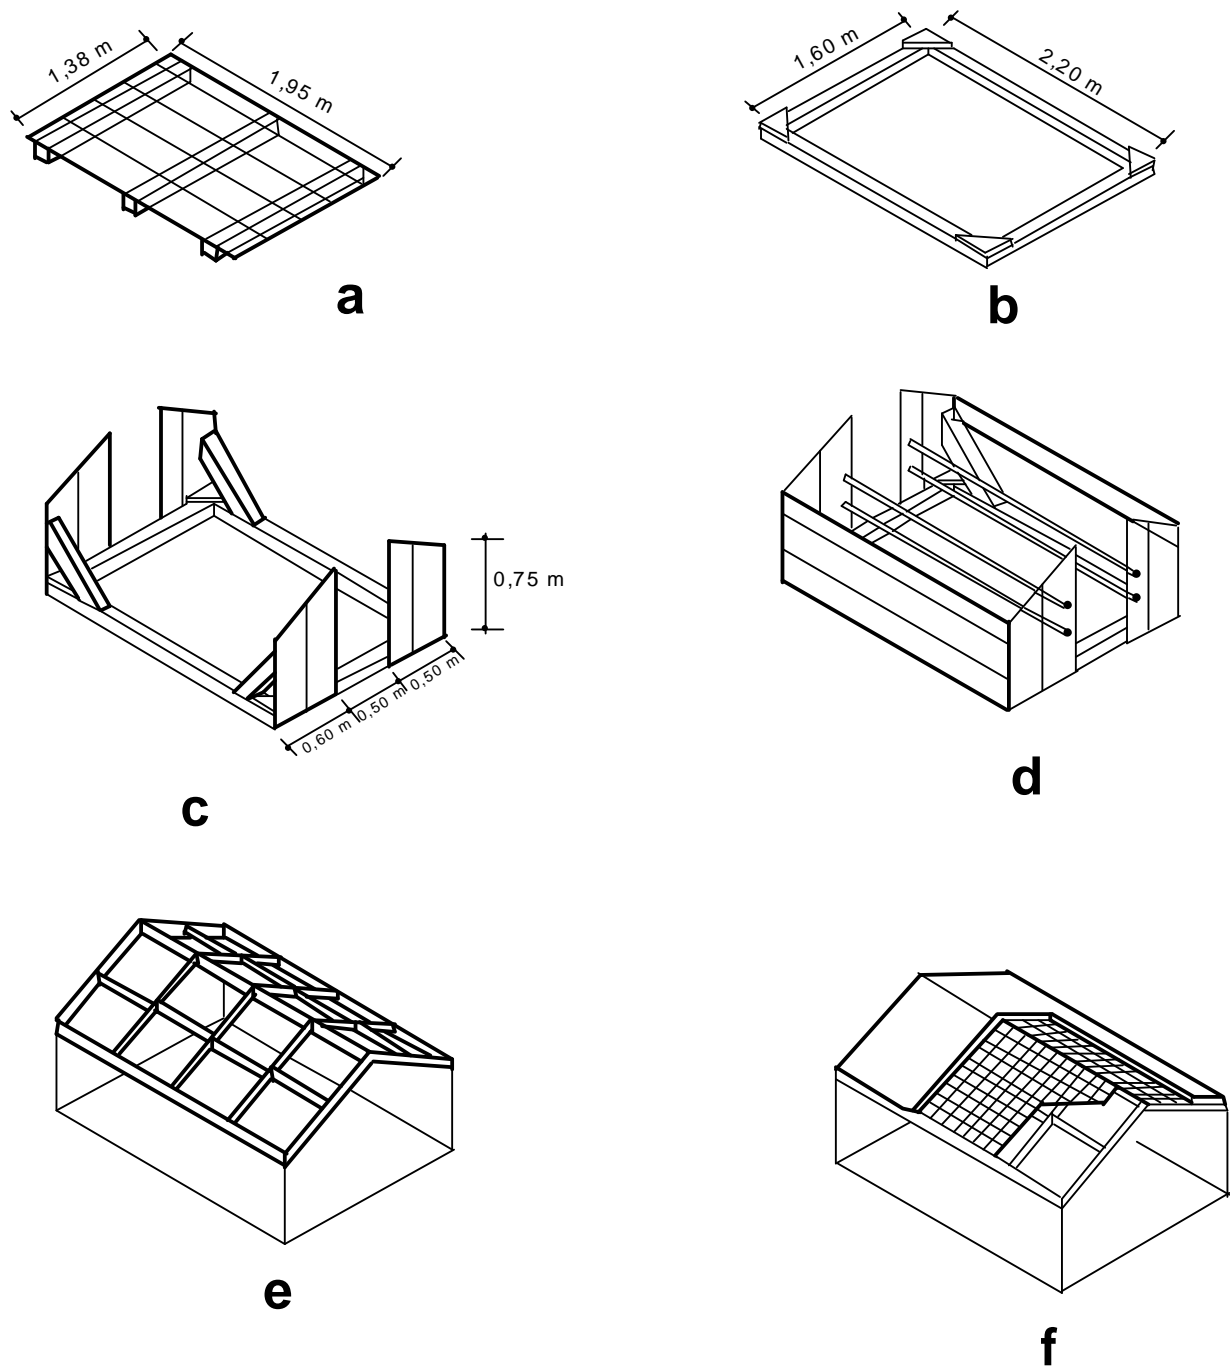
Cabana cela parideira: a) Estrado Independente (removível); b) Estrutura da cabana com cantoneiras de contraventamento; c) Cabeceiras e escoras; d) Laterais e canos de proteção aos leitões; e) Cobertura: estrutura de madeiramento; f) Cobertura: telhado sobre madeiramento e palhada sobre telado.
